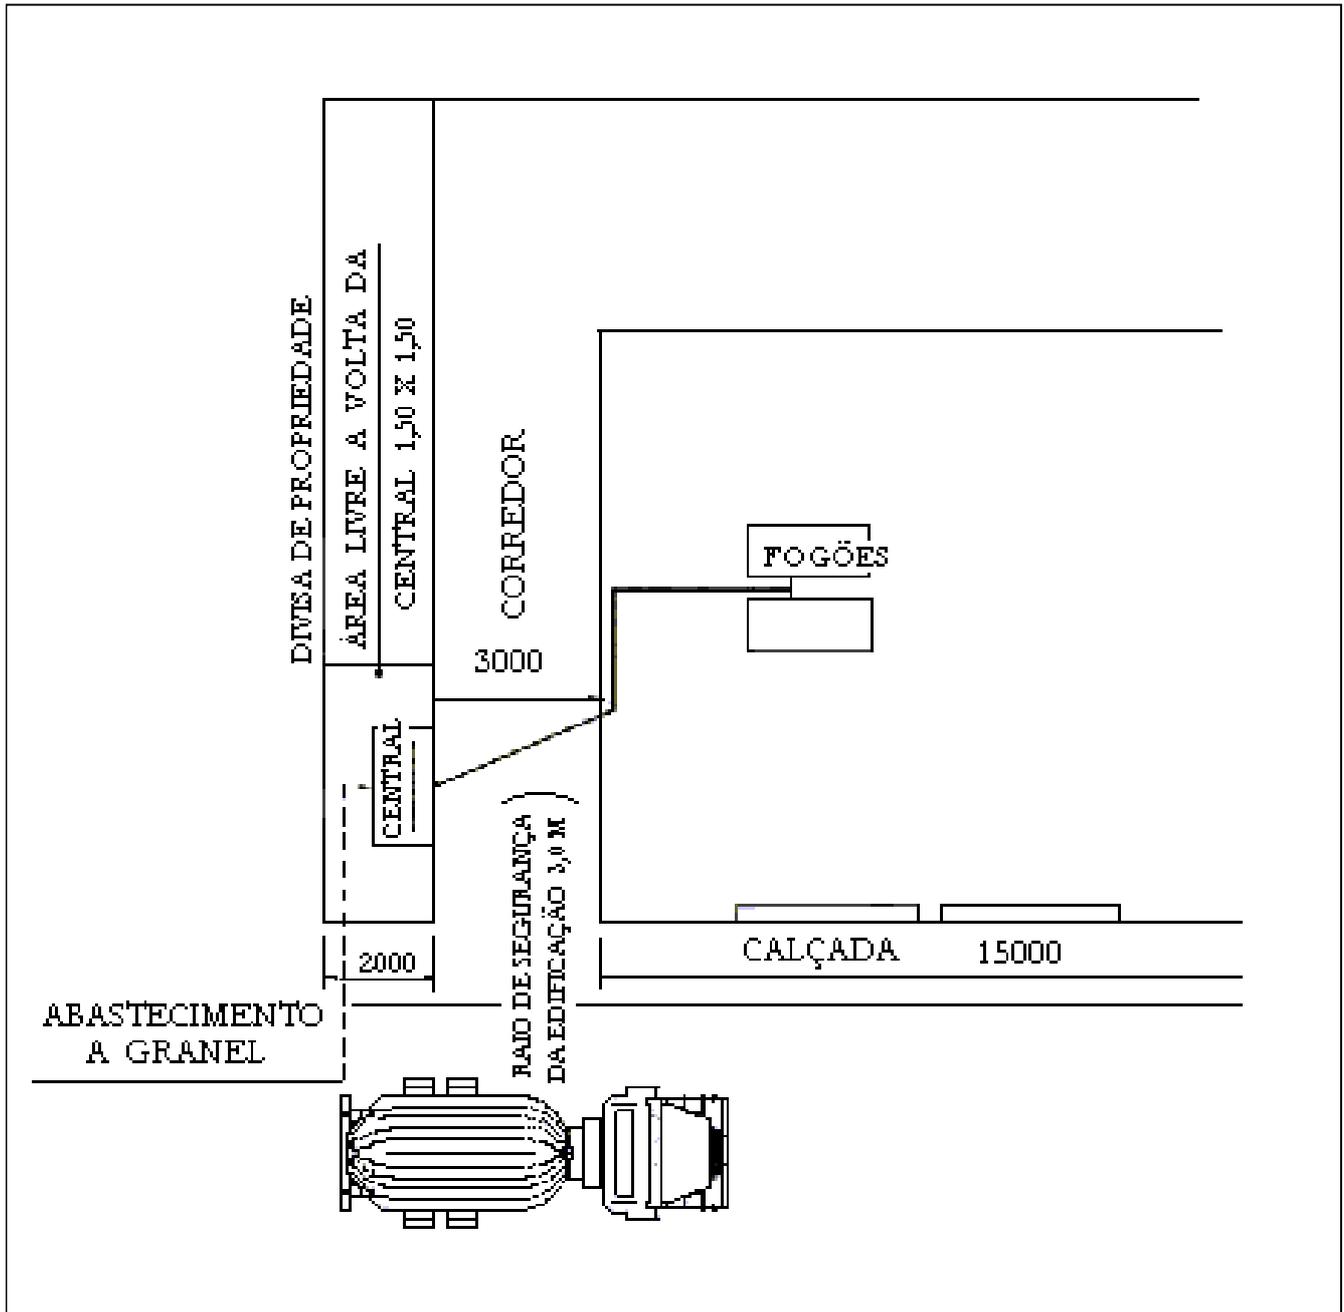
PLANTA BAIXA DA CENTRAL DE GLP
